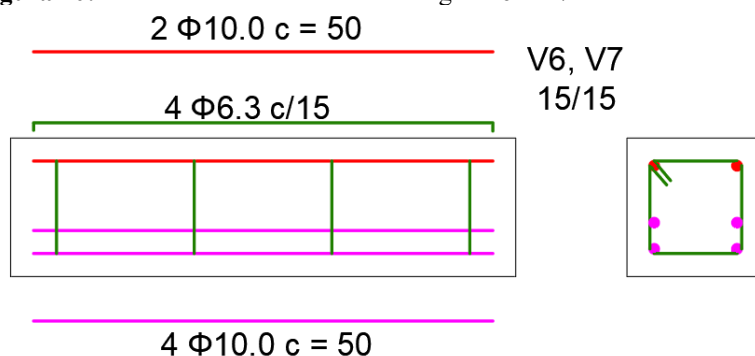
Detalhamento armaduras das vigas V6 e V7 armadas em fibra.
